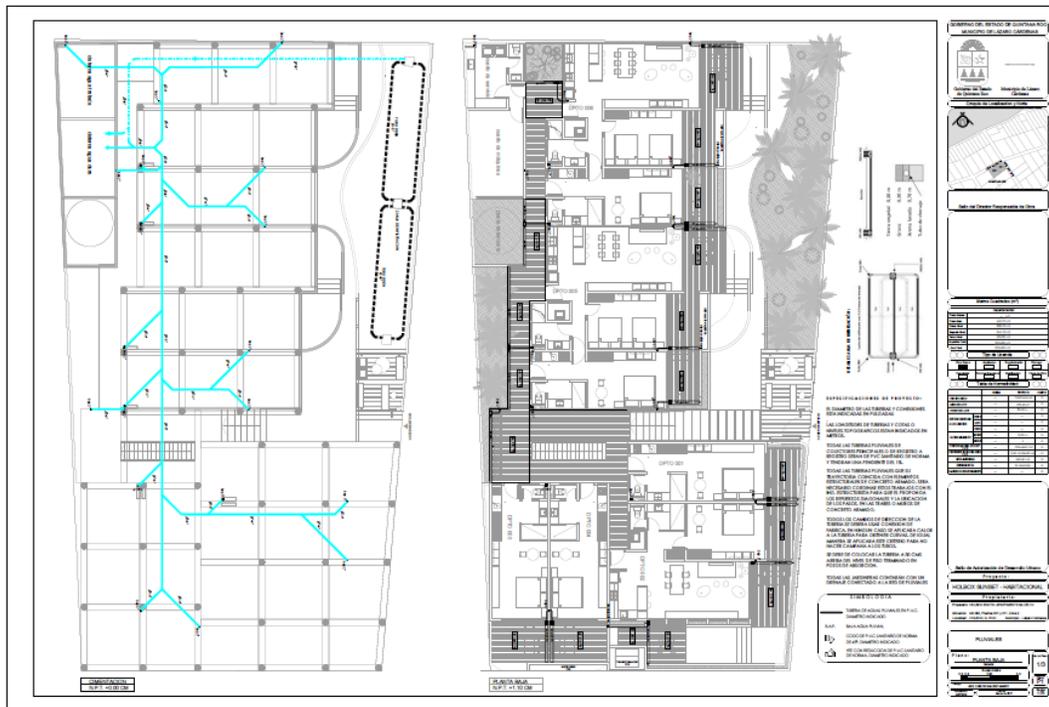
Visualización del sistema de canalización de agua pluvial en planta baja del proyecto.
